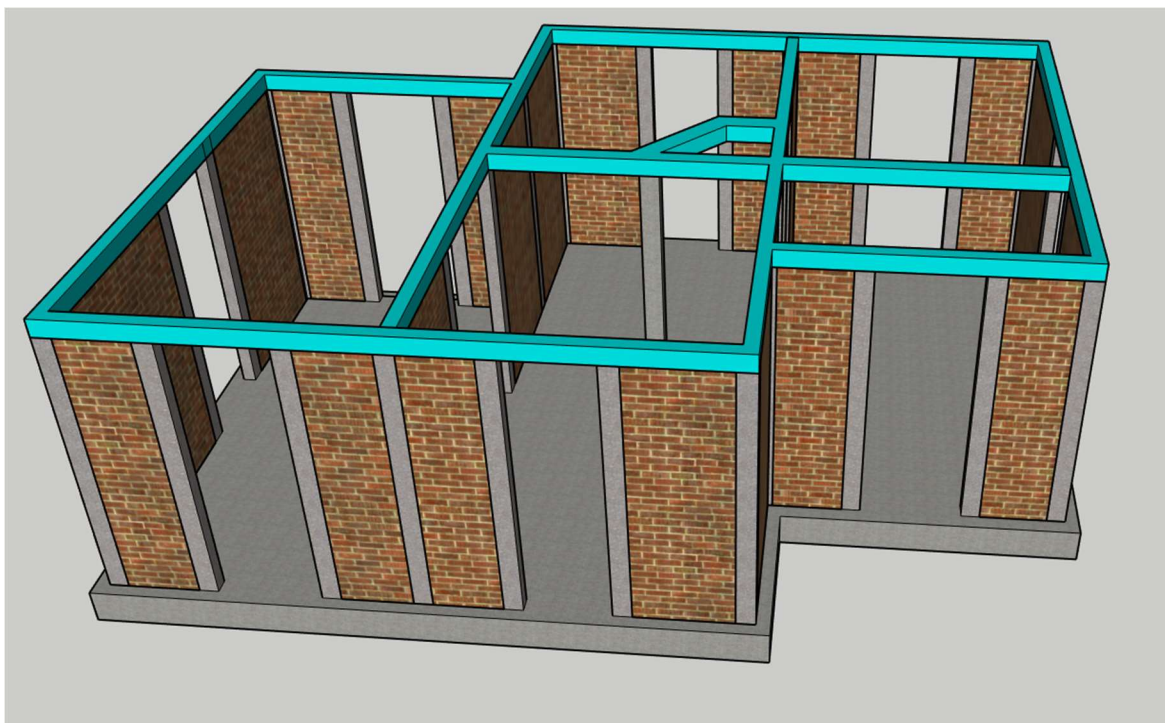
Vista desde la parte superior de las columnas de confinamiento fundidas
